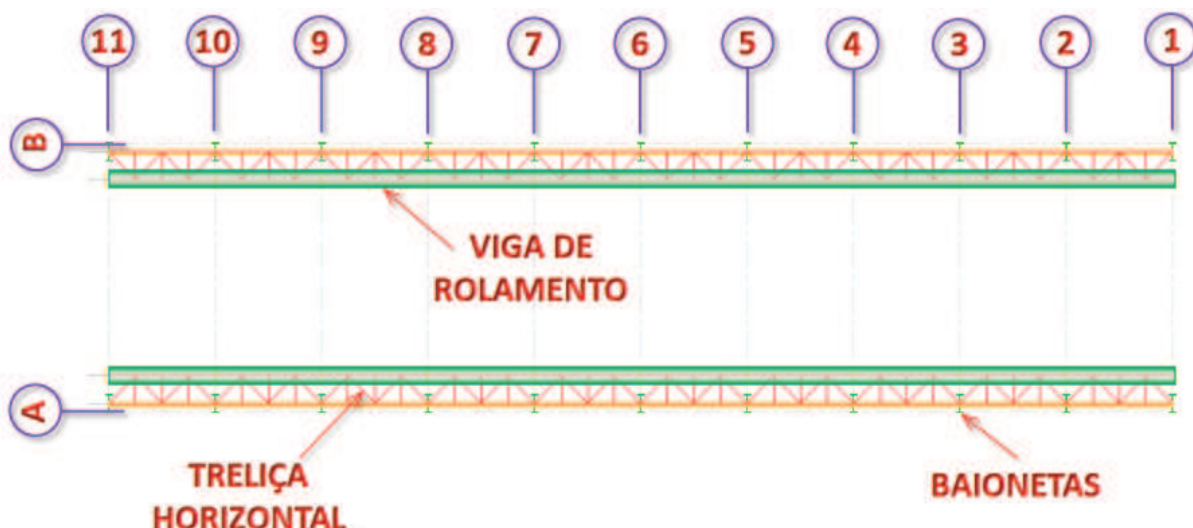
Planta do topo da viga de rolamento, El +44,000 m.
